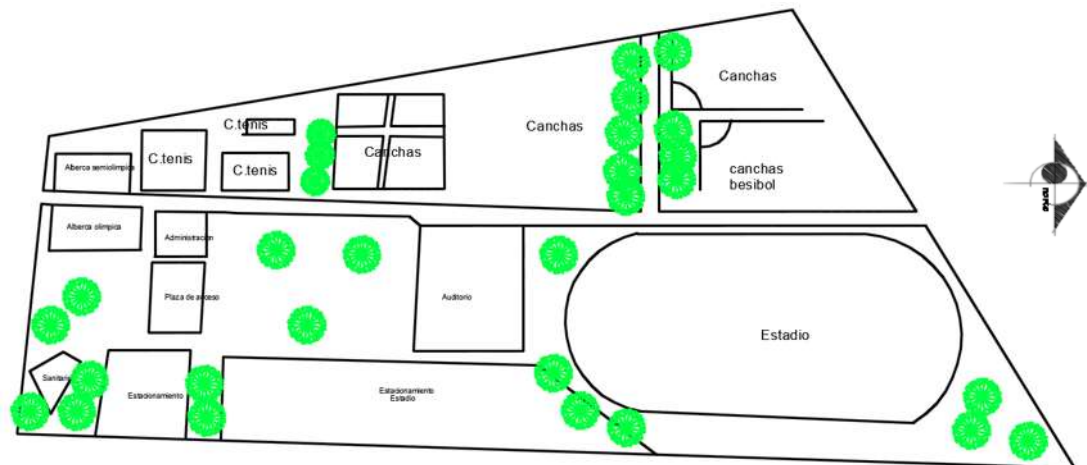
Muestra Croquis planta de conjunto Fuente: Dibujó MACR
